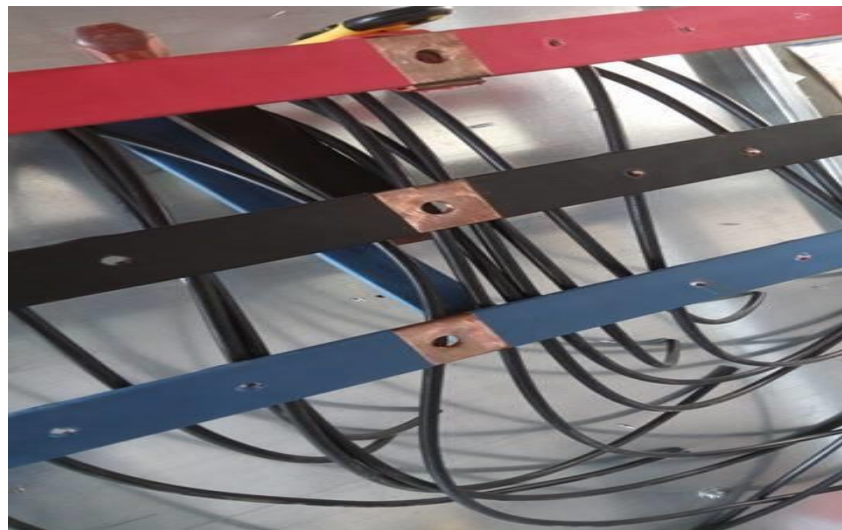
Platinas con mangas termo contraíbles en tablero auto soportado
